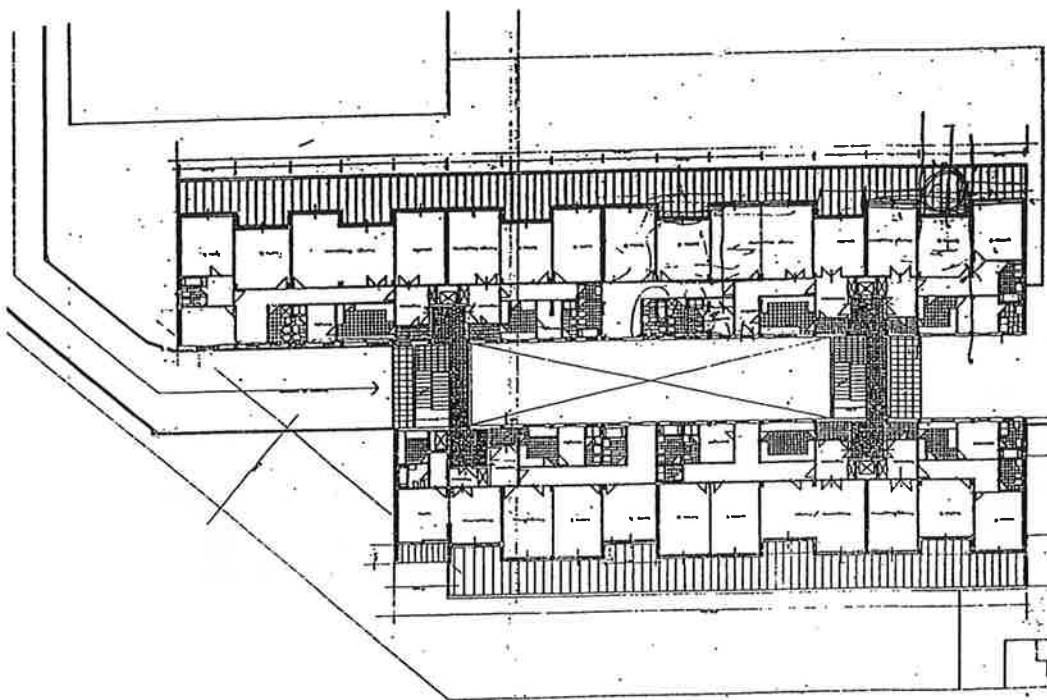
Edificio a Roma EUR : pianta piano tipo
